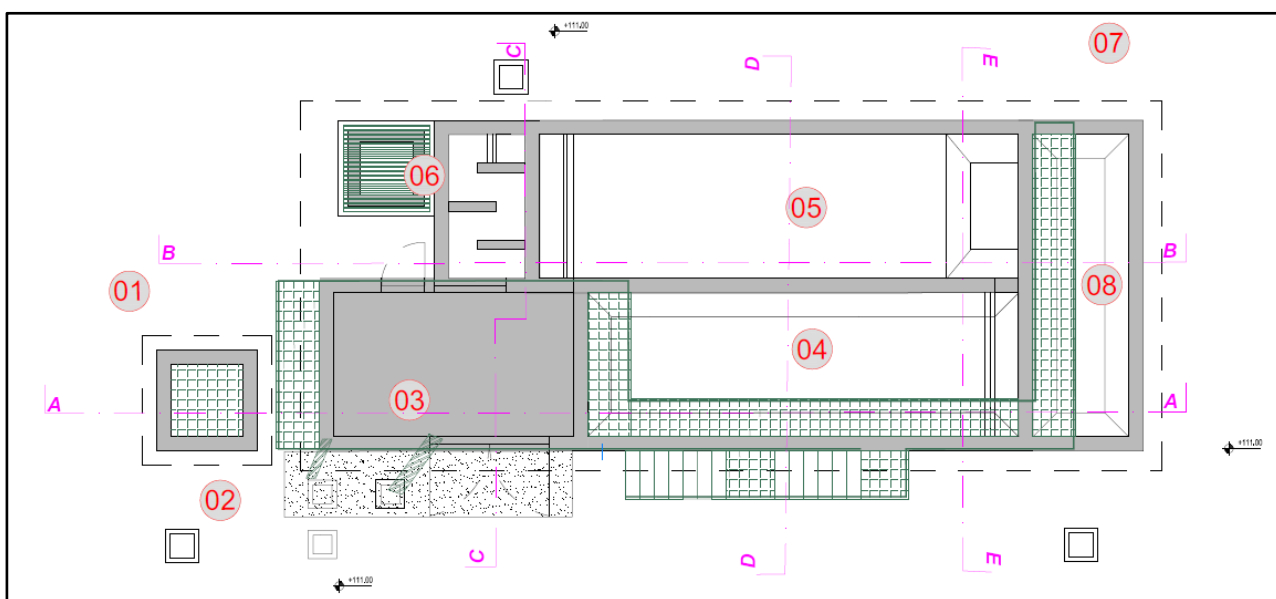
Planimetria impianto di depurazione in progetto (DA Sollevamento e monoblocco - opere civili: Pianta e sezioni).
